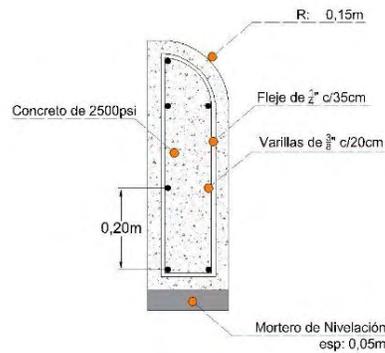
Detalle Sardinel Tipo Sencillo.
